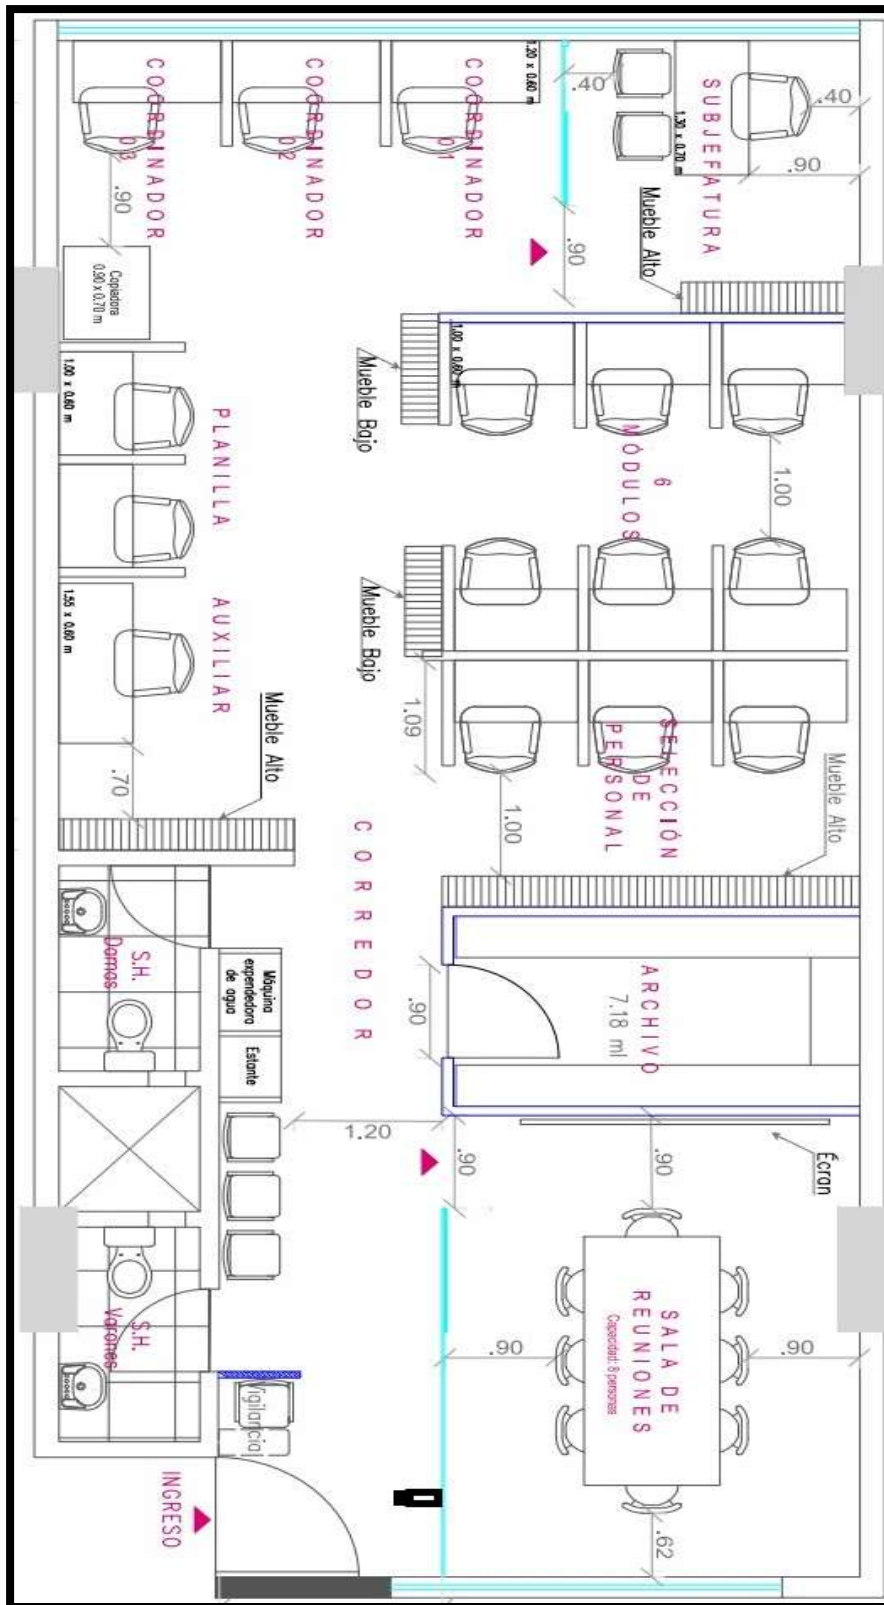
Plano de distribución de oficinas y área 1004.
